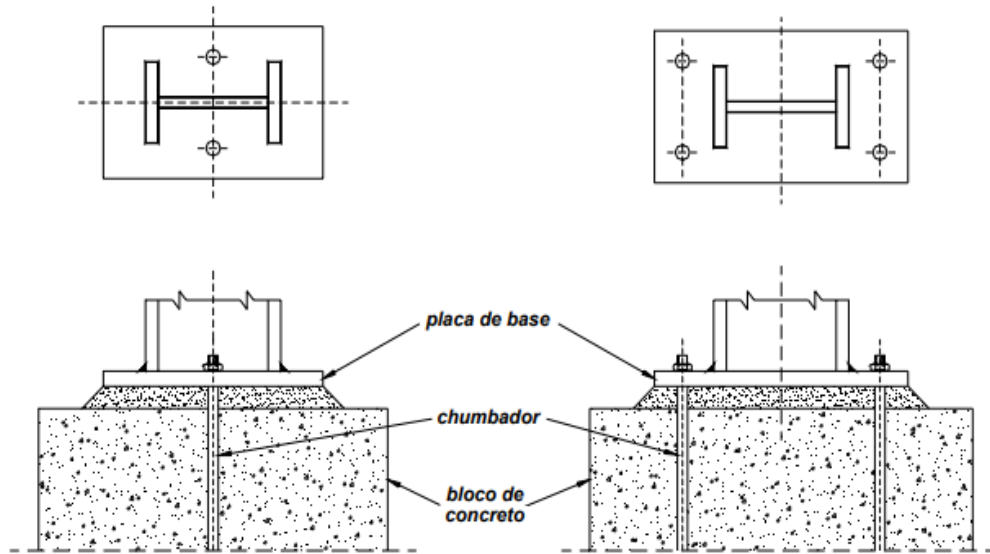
Apoio rotulado e apoio engastado (MARTINS, 2002)
